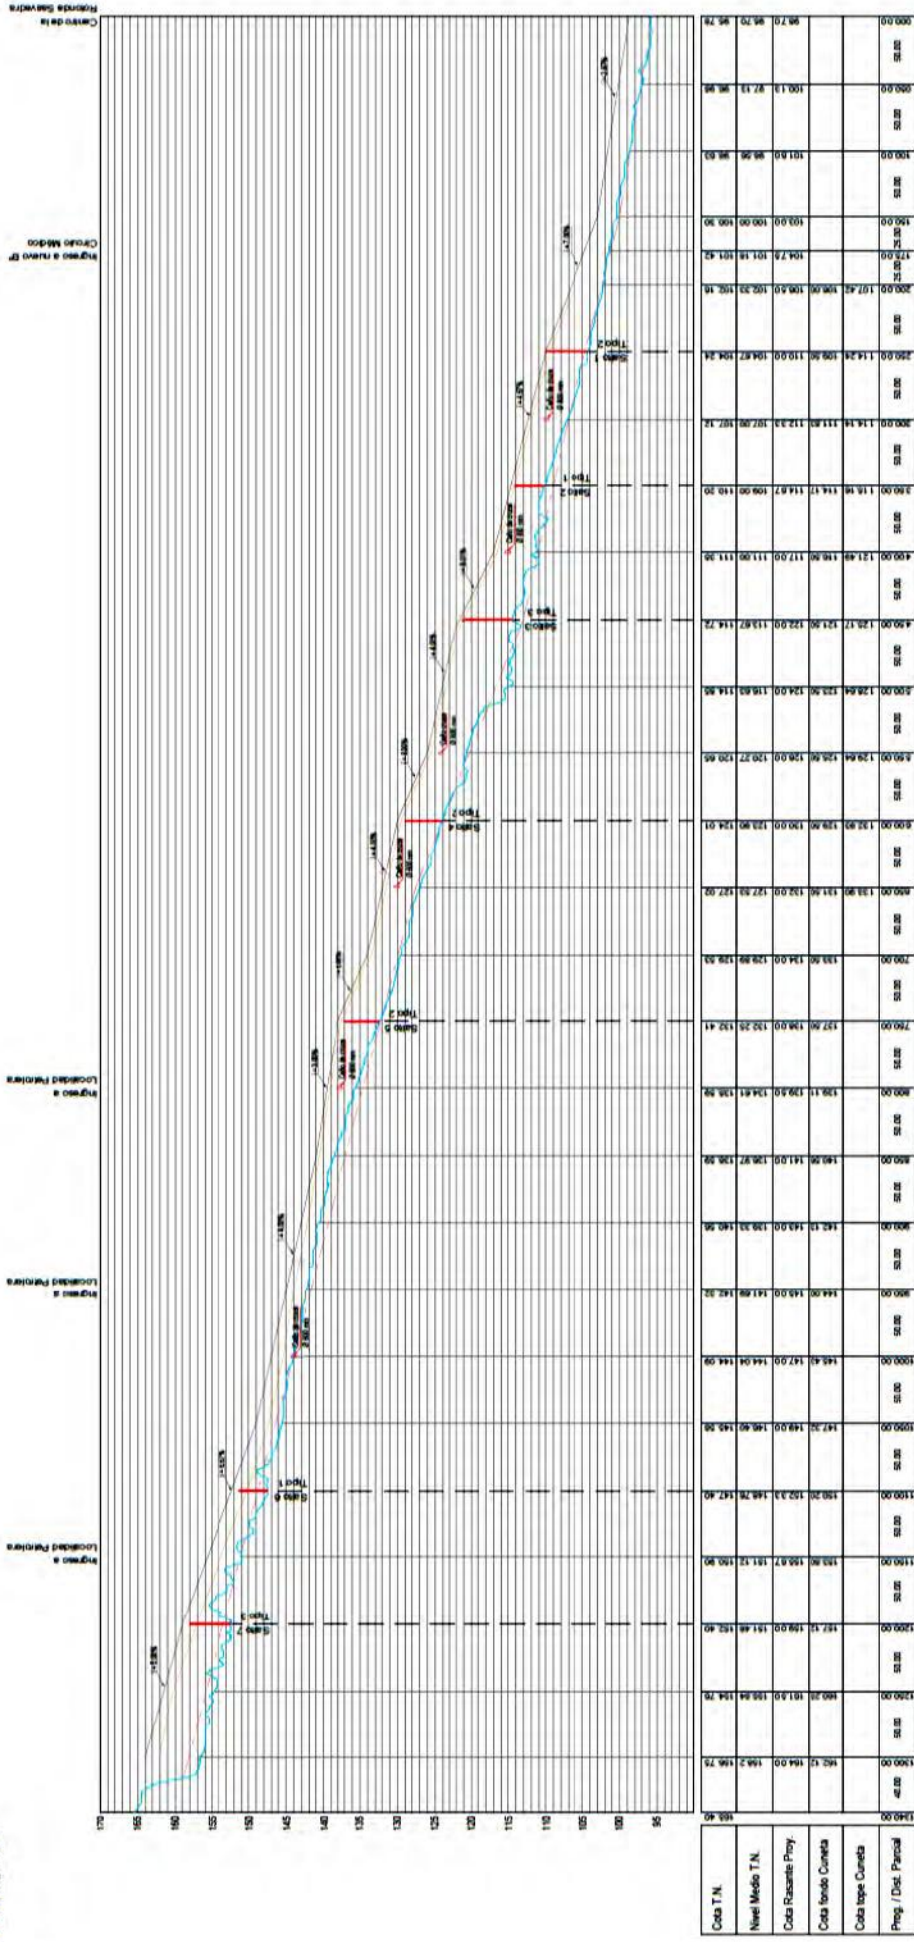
Perfil longitudinal del camino al Barrio Laprida.
